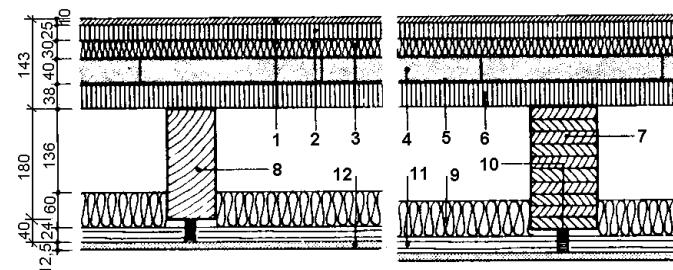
Деревянные балочные перекрытия. Вариант VI.
